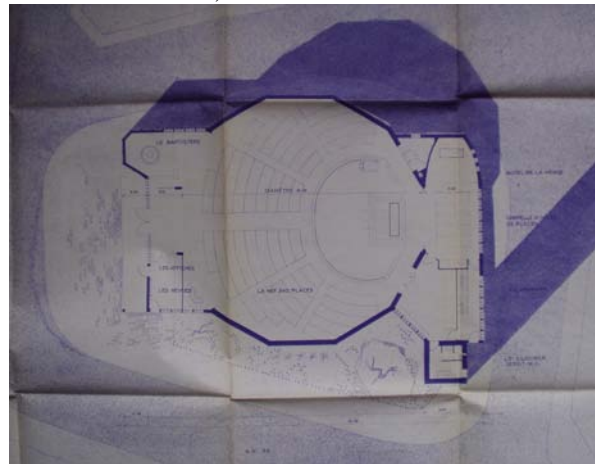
Plan 15-11-54 (AD Cambrai Dossier CAS)
